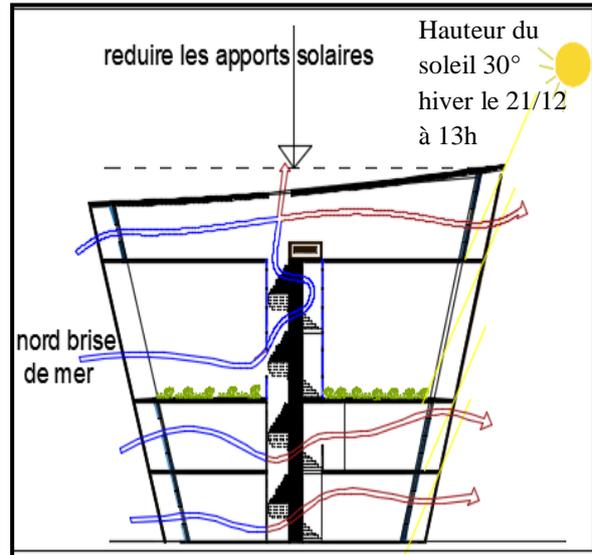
coupe montrant la ventilation naturelle et la protection solaire par les toits inclinés
